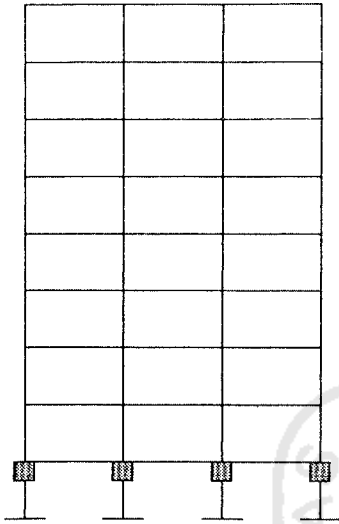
Tingkat 7 lantai ke 5
